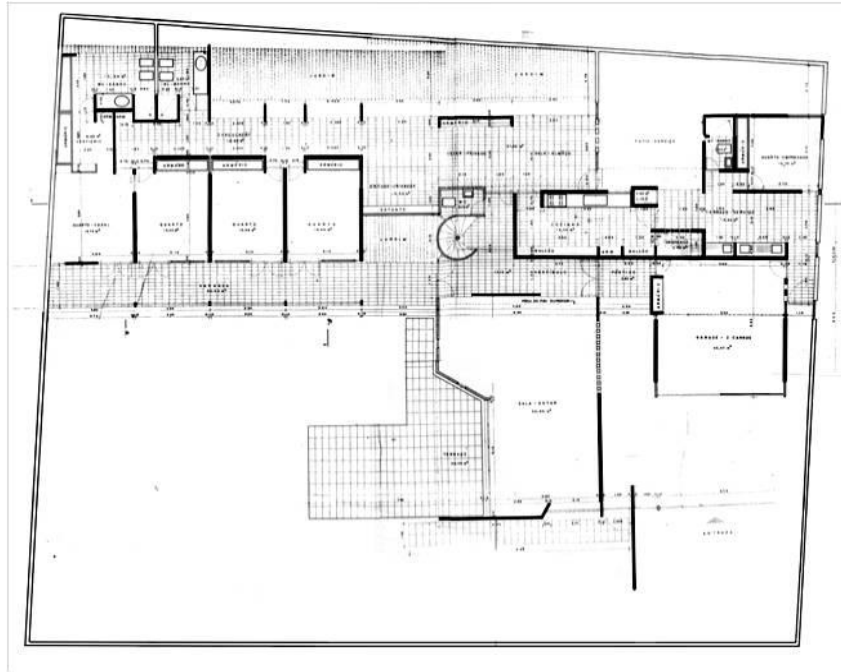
Planta baixa da Residência Paulo Meirelles.
